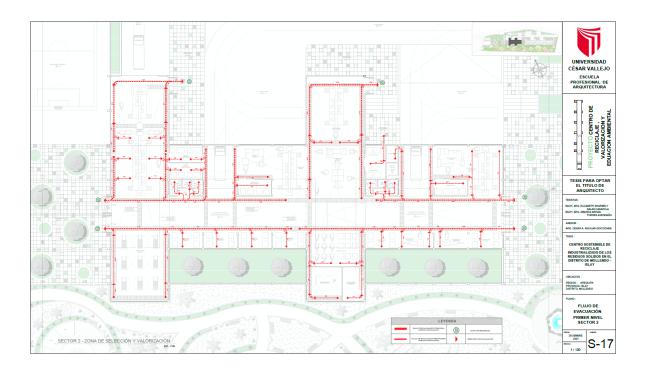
Plano de Evacuación, Sector 2 – Primer Nivel FUENTE: Elaboración Propia
